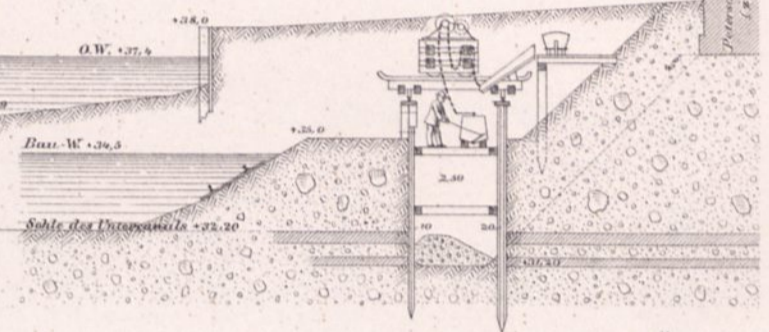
Längenschnitt durch das Betonirungsgerüst. 1:200.
